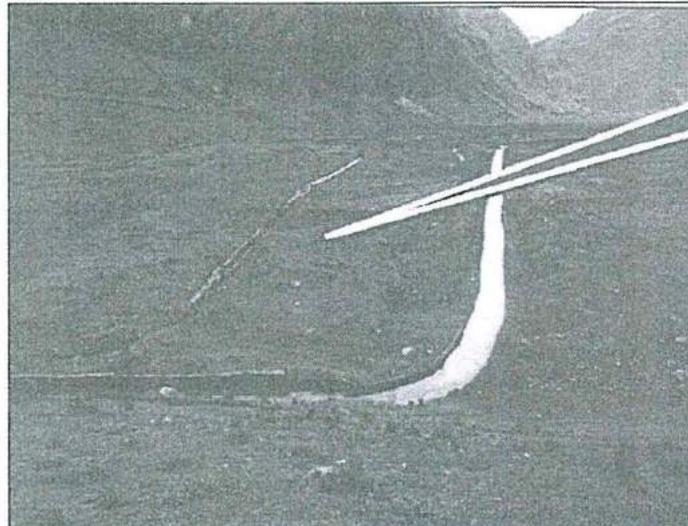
Vista Aguas arriba canal de coronación de mampostería zona norte.
